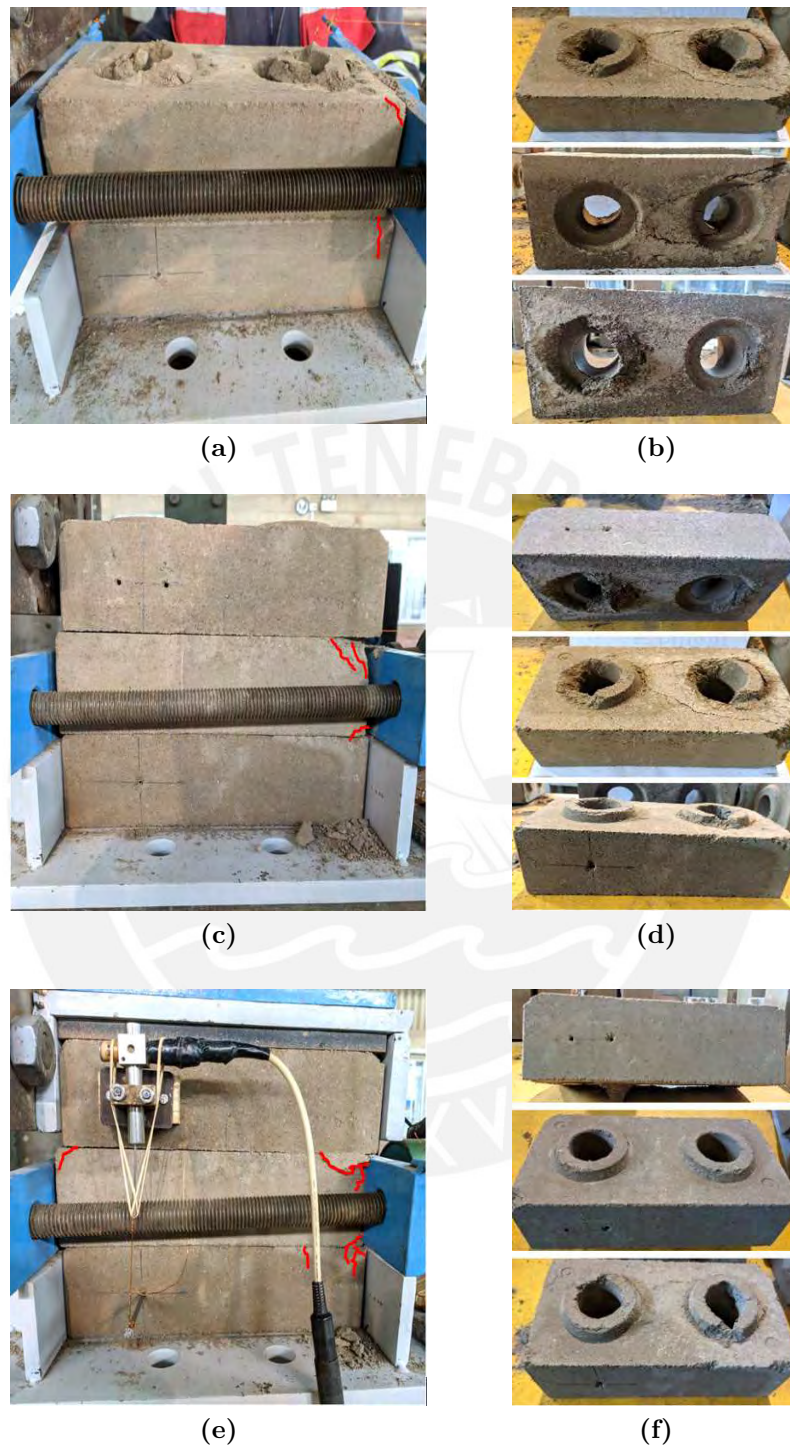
Patrones de falla en pila PCL bajo un esfuerzo de precompresión de 0.15 MPa: (a-c-e) grietas en la vista frontal de la pila y (b-d-f) fallas generadas en las unidades.
